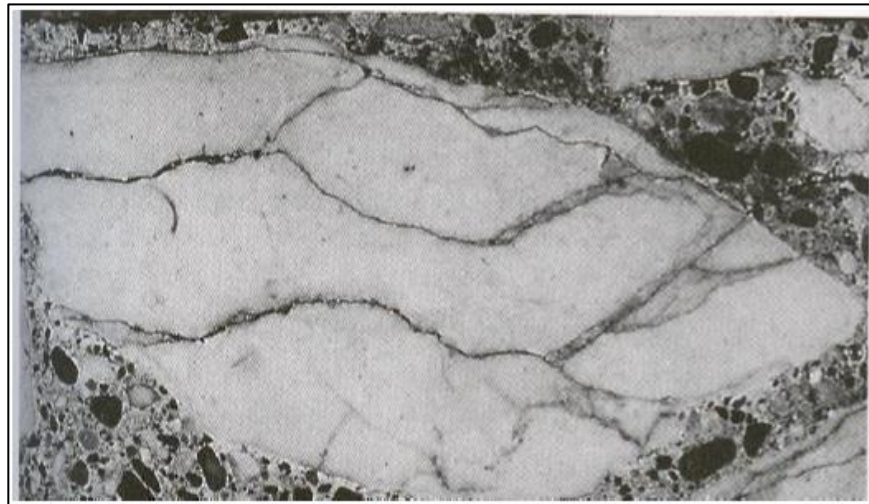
Agrietamiento del concreto, debido a la reacción álcali-agregado.
